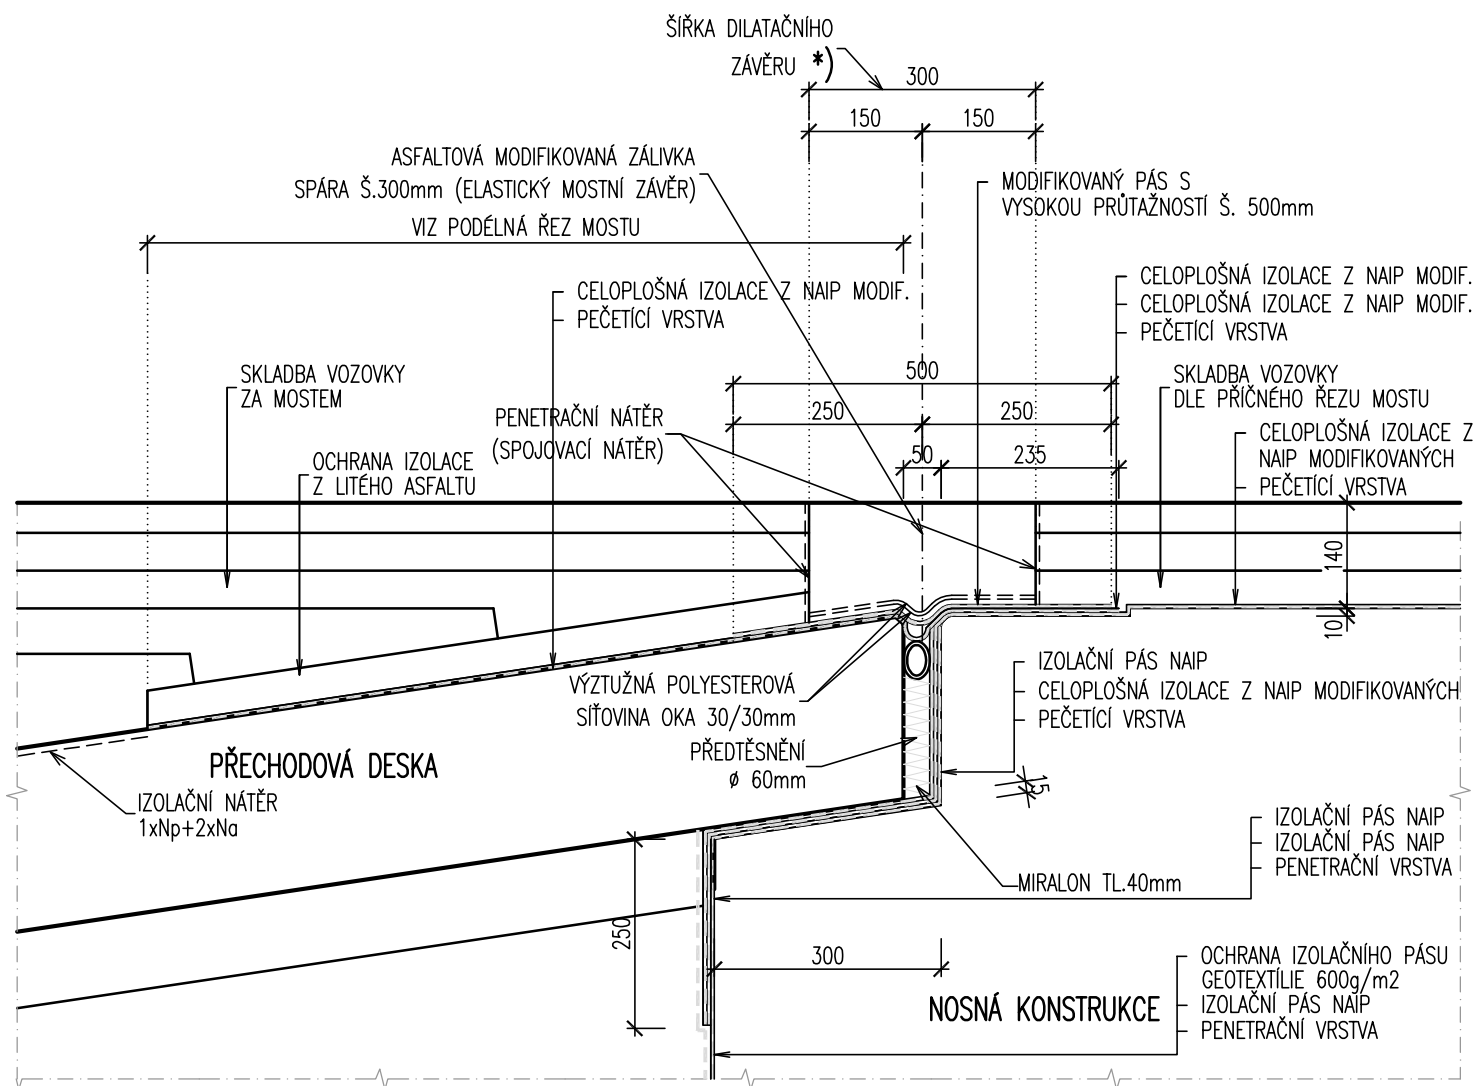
POVRCHOVÁ DILATACE KONSTRUKCE VOZOVKY	1 : 10
